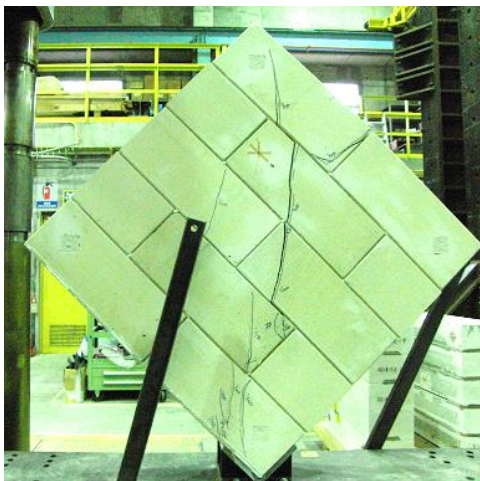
載荷後の試験体とひび割れ図
